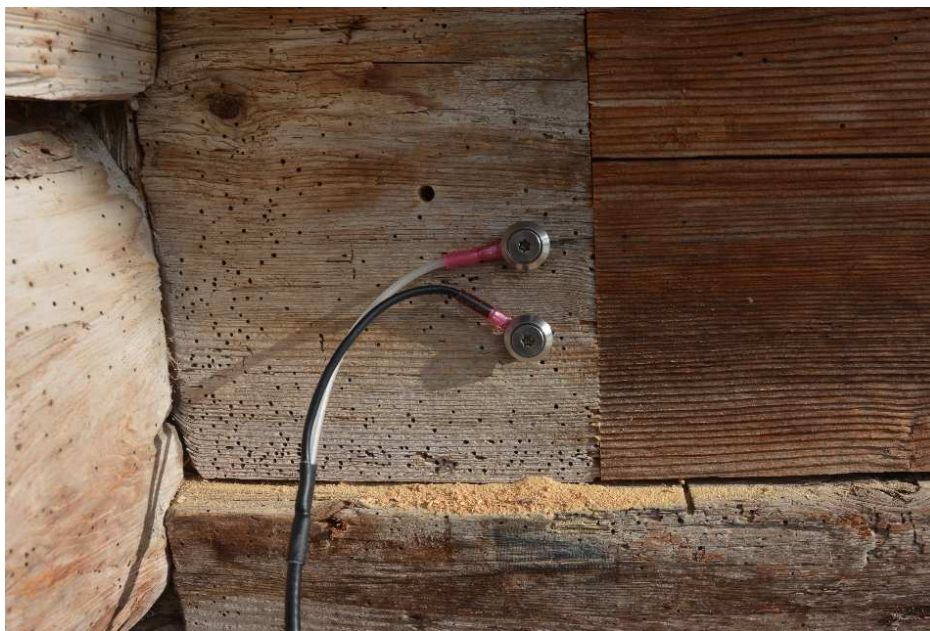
Fertig installierte Holzfeuchtemessung. Links oben ist das Probeloch zu erkennen. Dieses wird anschließend mit einem Holzdübel verschlossen
